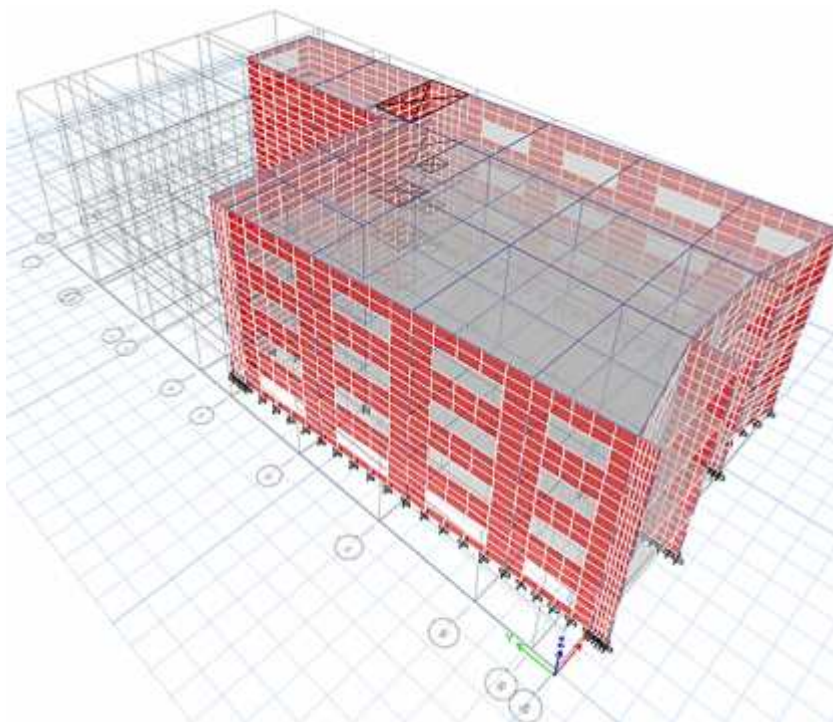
Modelo estructural 3D Etabs v15.2. Segunda alternativa.
